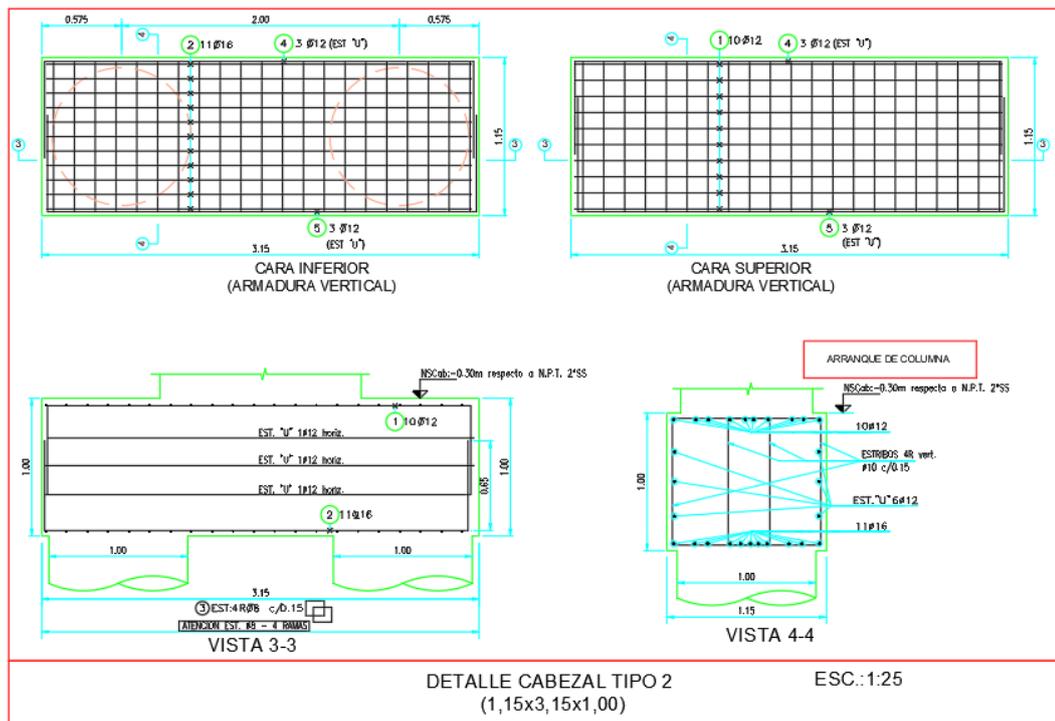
Detalle del cabezal tipo 2. Corte 33 y 44.
